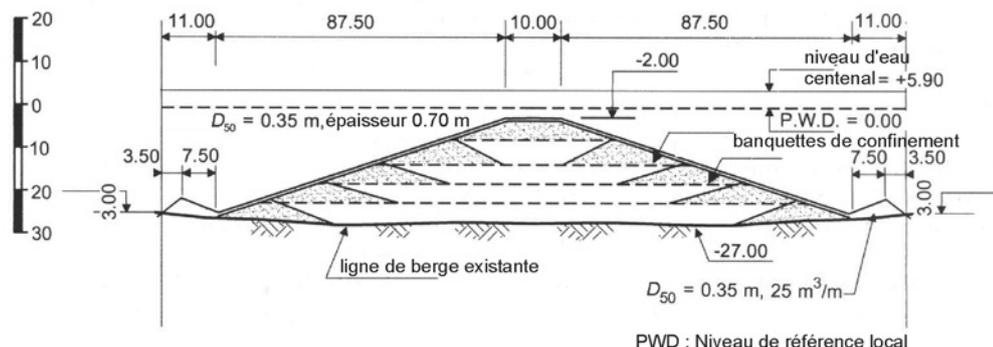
Coupe d'un épi construit à l'aide de banquettes de confinement (dimensions en m)
